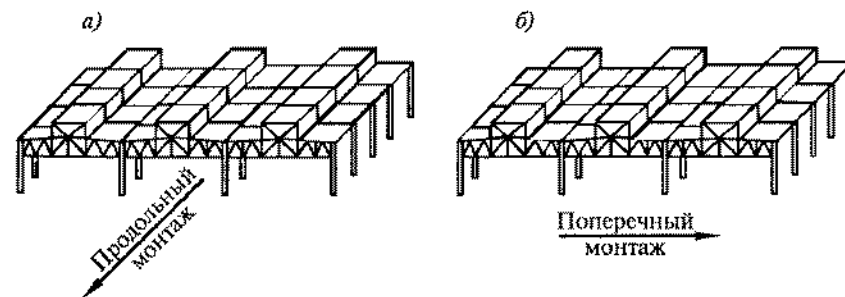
Схемы продольного (а) и поперечного (б) монтажа каркаса здания
